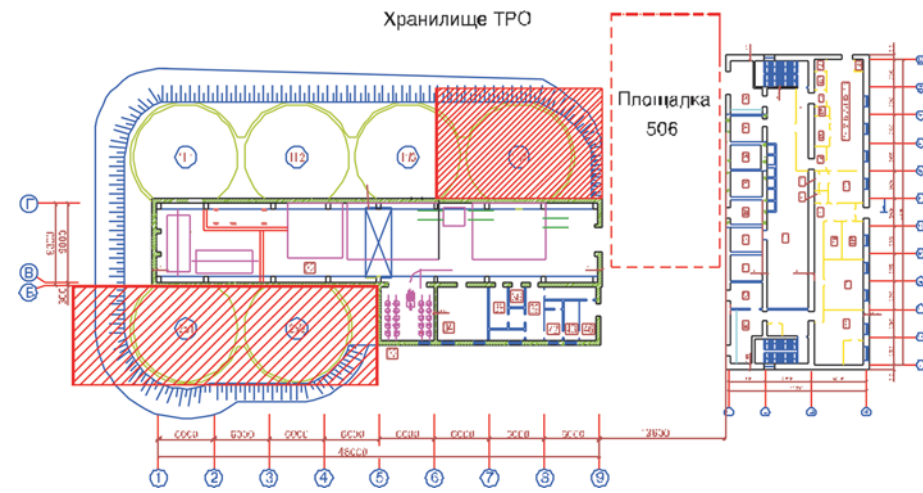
Схема расположения зданий и укрытий для размещения оборудования цеха ЖРО по альтернативному варианту
